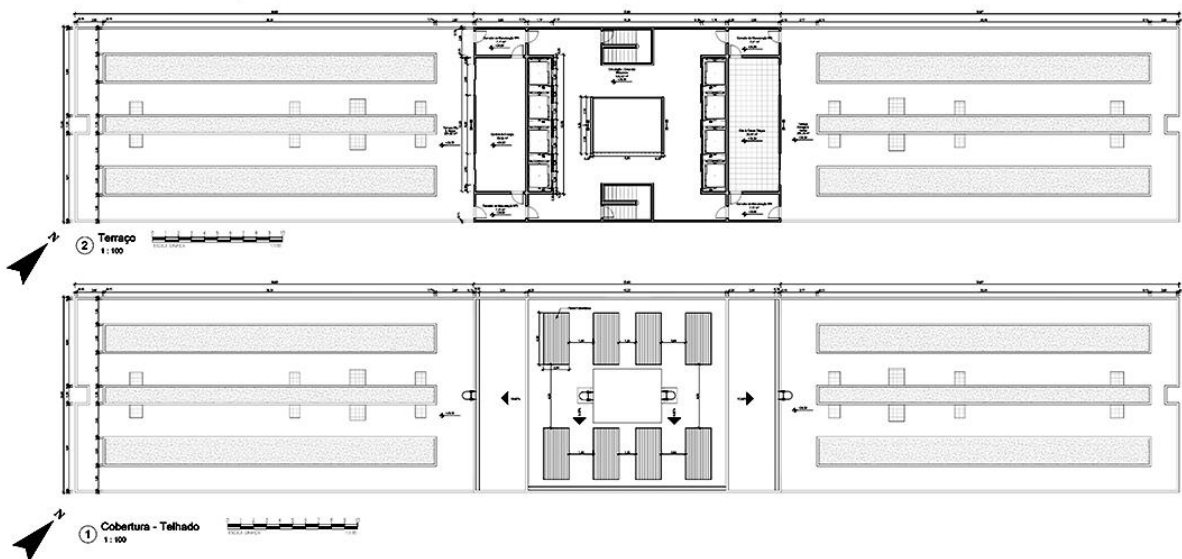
Planta Cobertura e Terraço – Projeto Sanctum.
